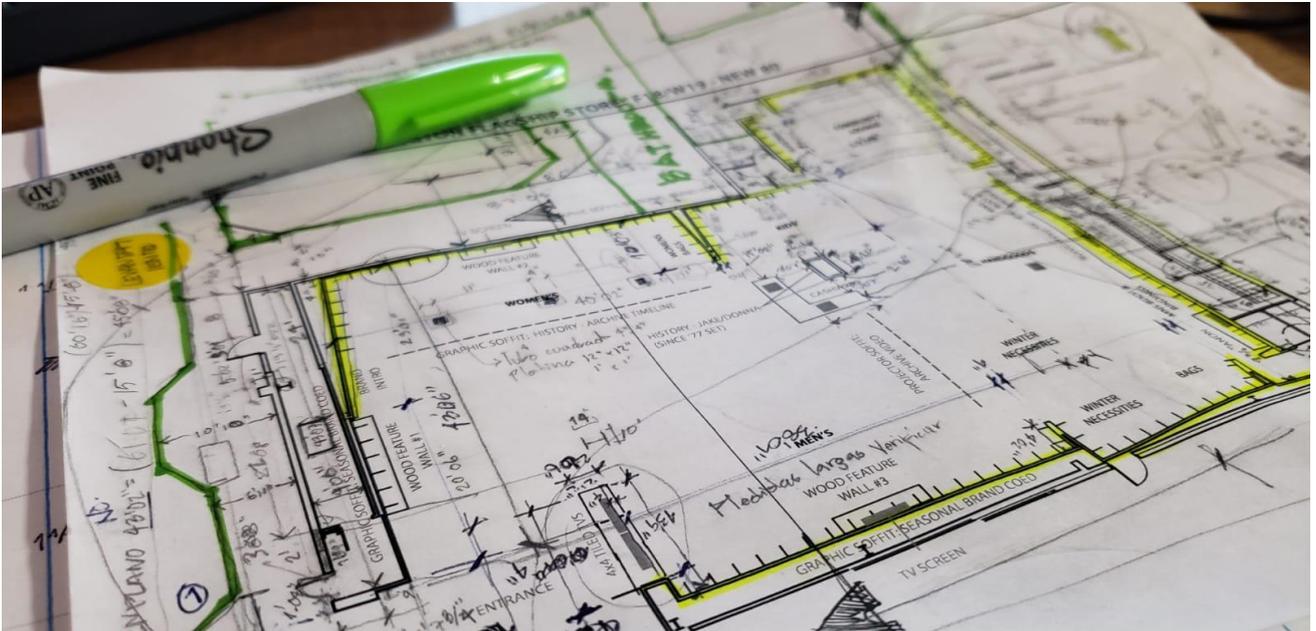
Ilustración a mano alzada de vista en planta.
